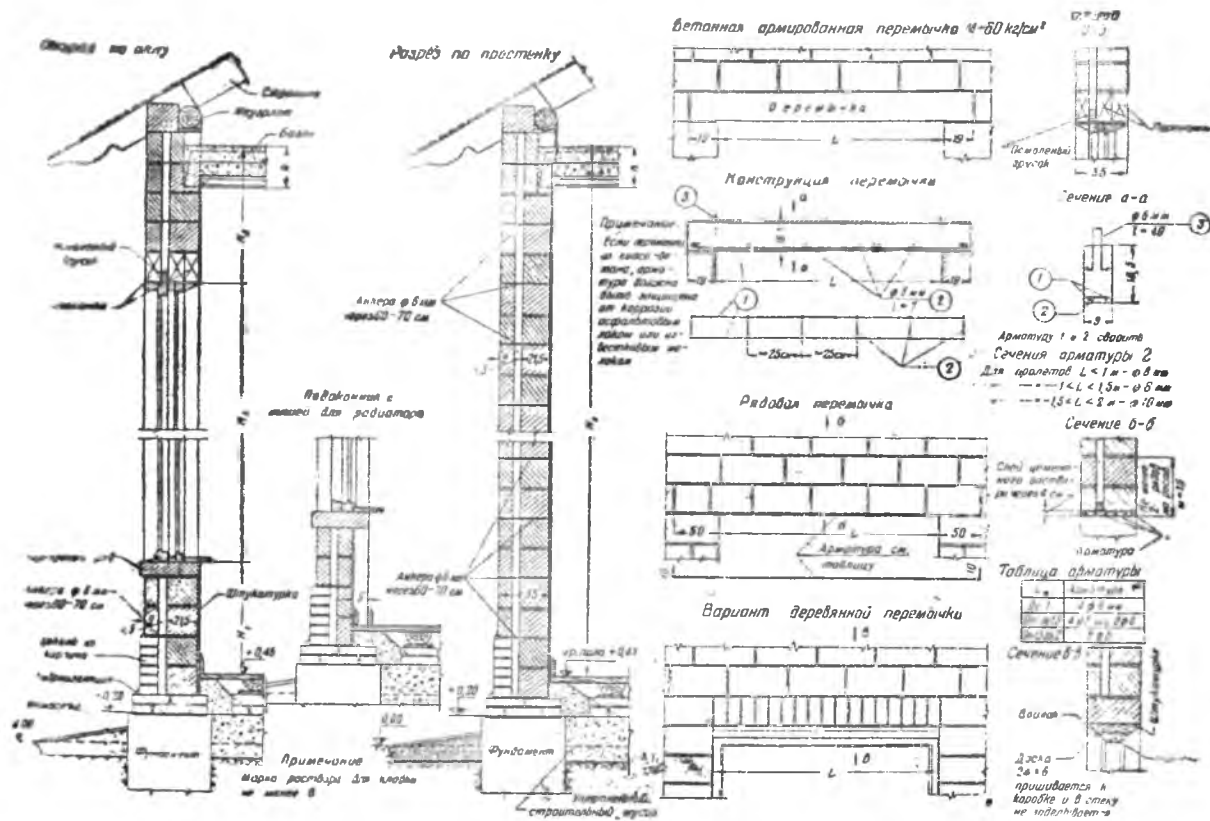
Стены с воздушным прослойком из разных блоков. Разрезы по одноэтажной стене, детали перемычек
